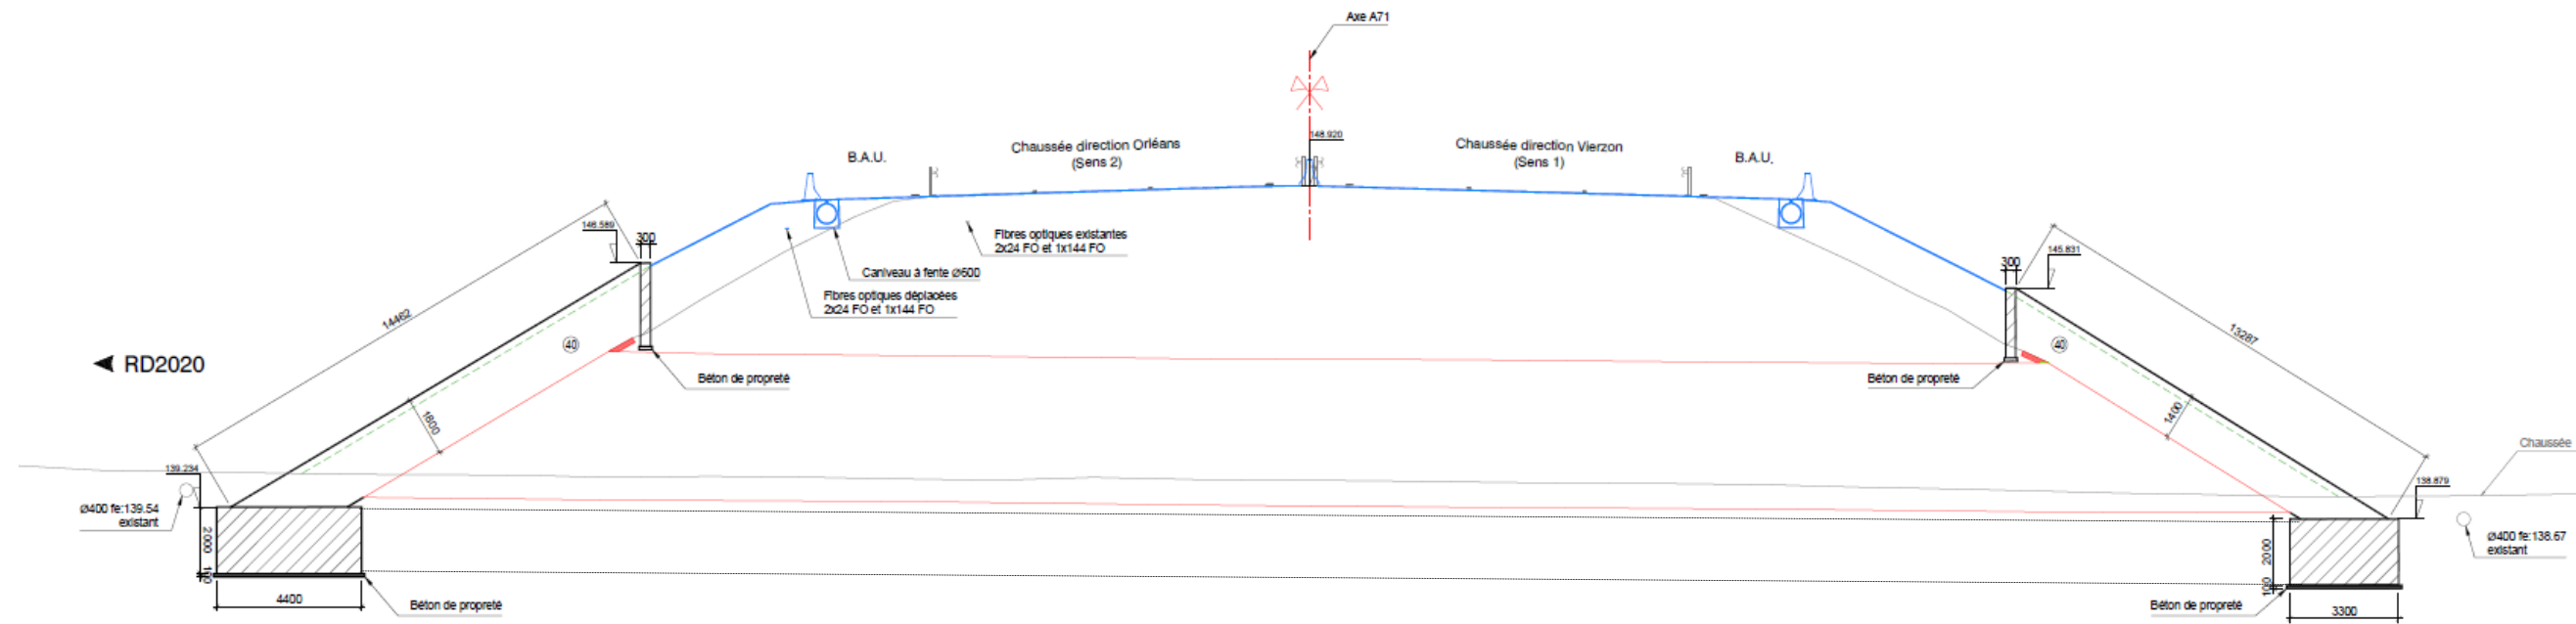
Vue en coupe de l'élargissement du remblai au niveau du passage inférieur rétablissant la piste forestière de l'Alouette
